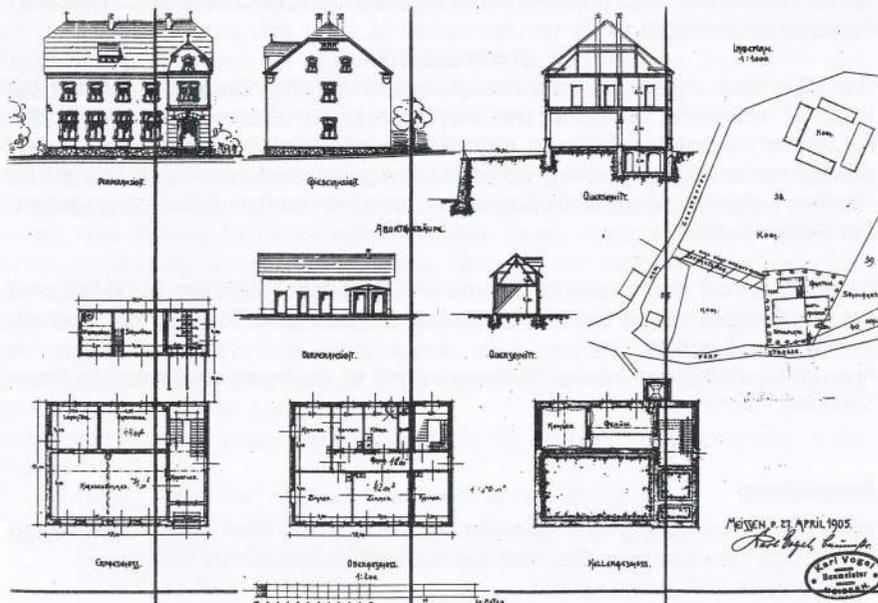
Endgültige Bauskizze 1905, rechts im Lageplan ist die östliche Erweiterung vorgeplant
